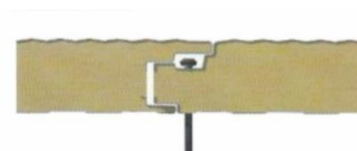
Detalle panel classwall. Encuentro Entre Paneles.
